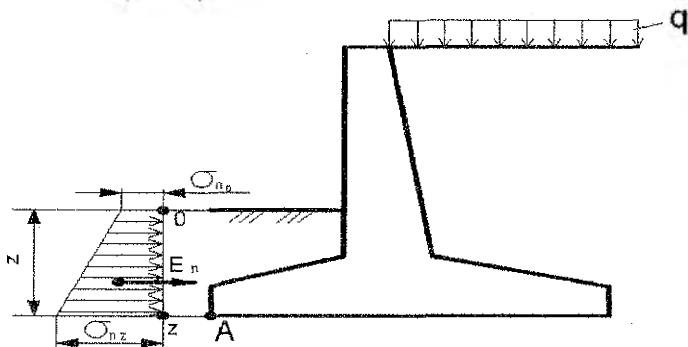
Схема к определению пассивного давления связного грунта на подпорную стенку
